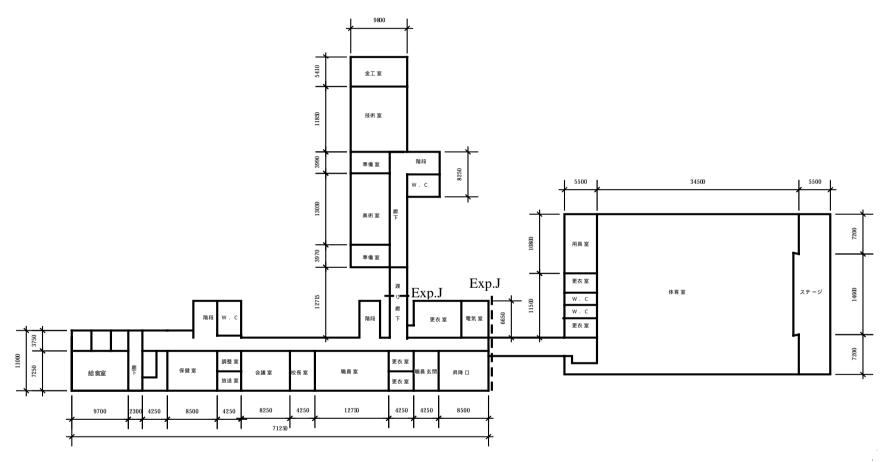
普通教室棟/特別教室棟/屋内運動場 1 階平面図
